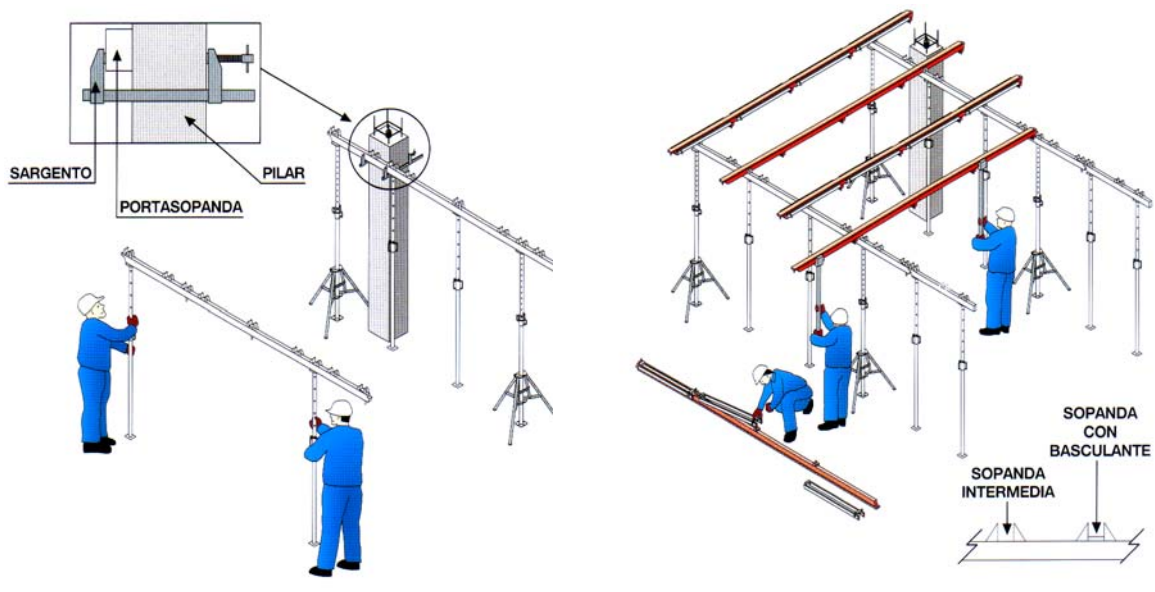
Montaje del encofrado del forjado previa colocación de los tableros.
